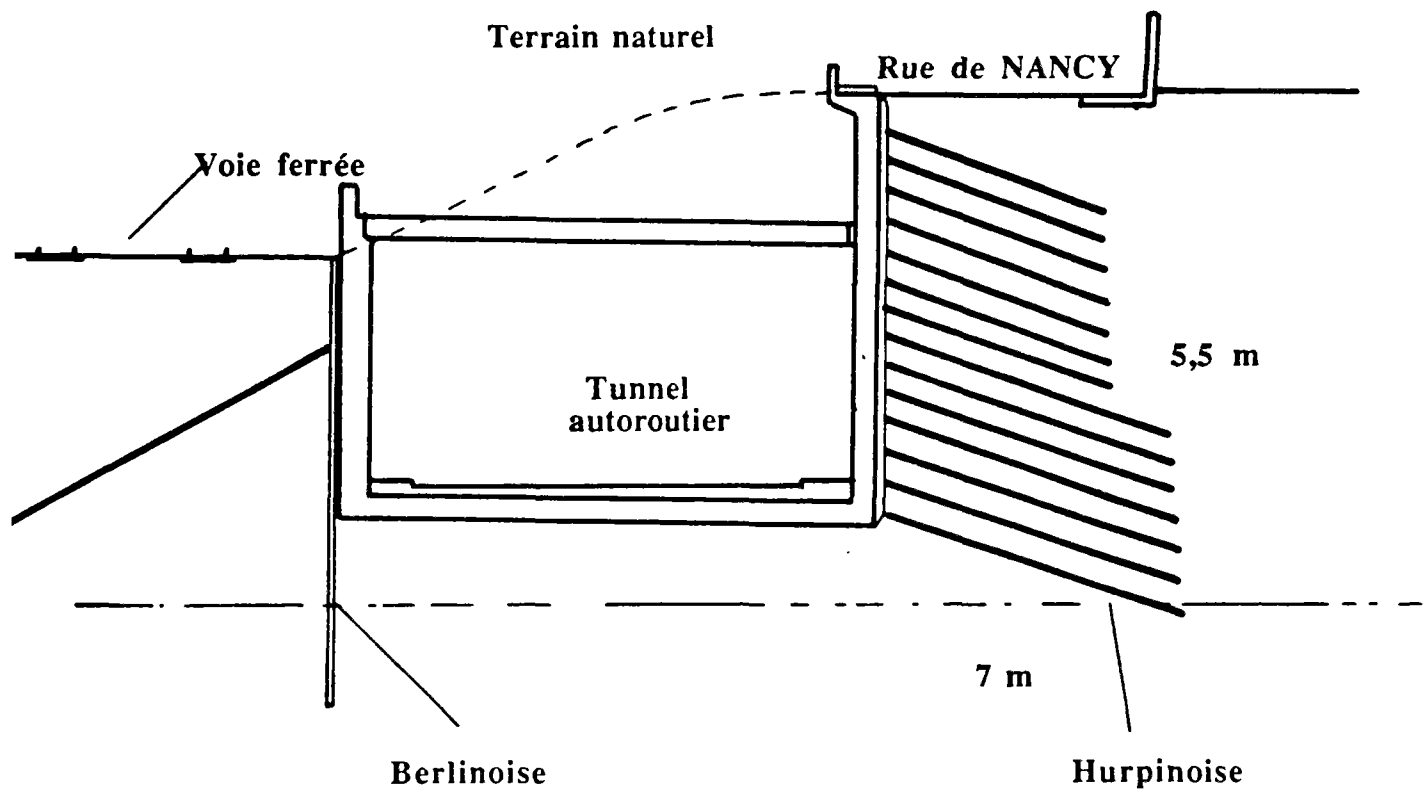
Coupe du tunnel autoroutier sur l'A 86.
